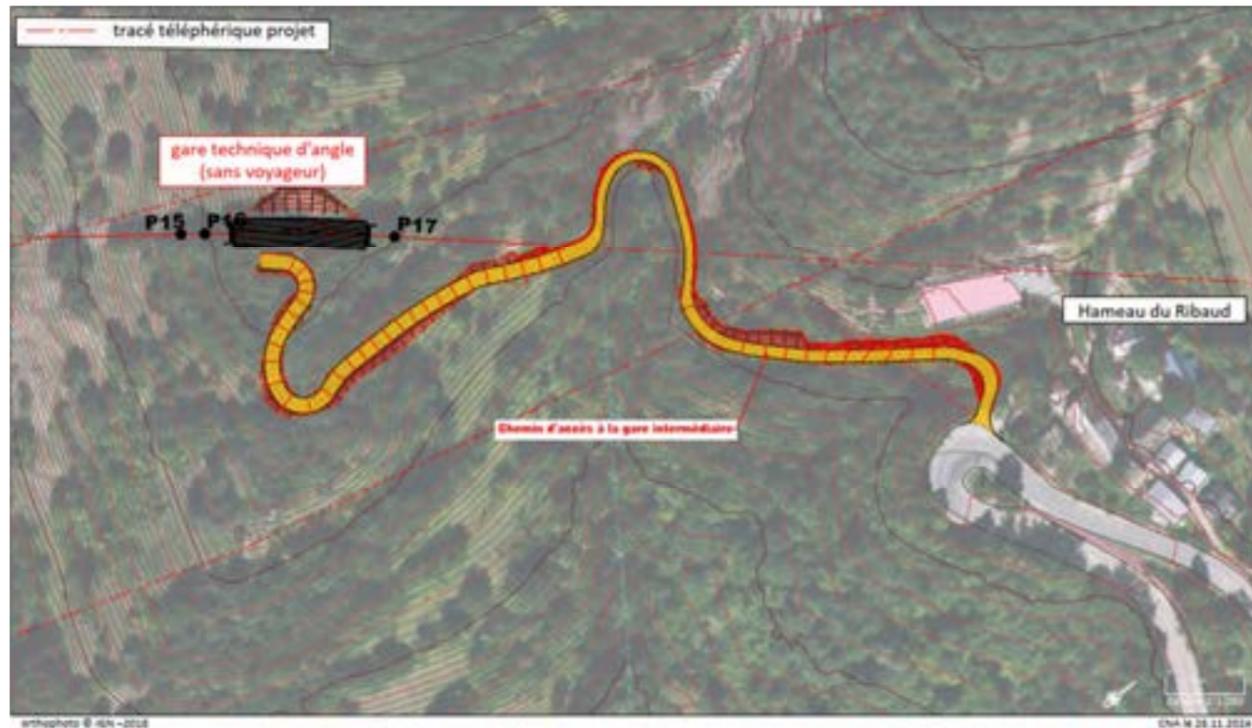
Plan général d'aménagement de la gare d'angle de la Garde (CNA, 2024)
